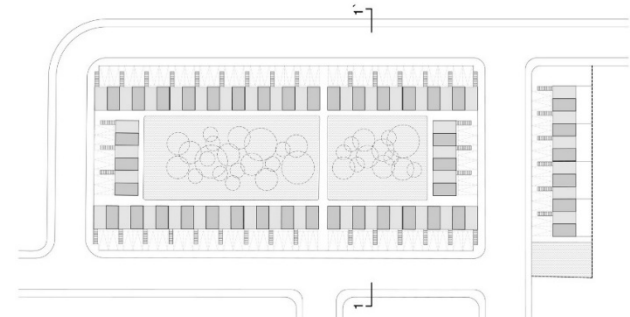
Planta de Conjunto proyecto habitacional ELEMENTAL
